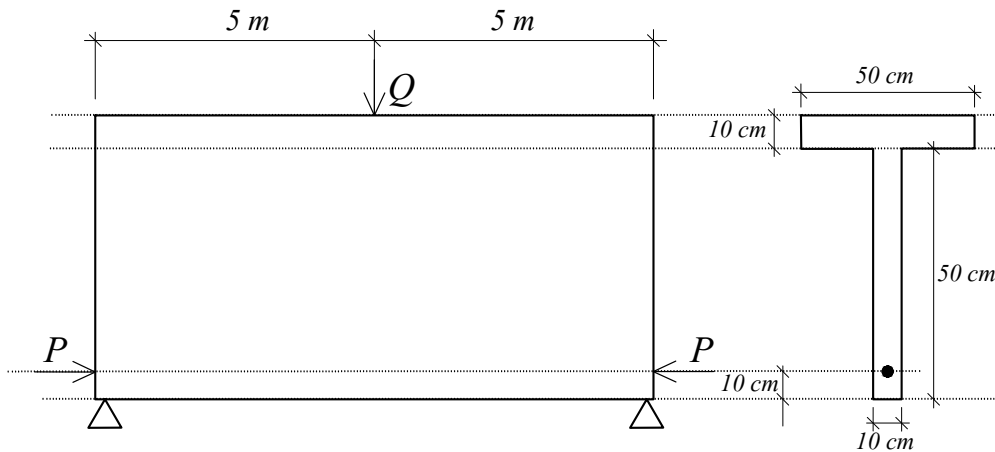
Viga com carregamento, geometria da seção e posição da protensão
